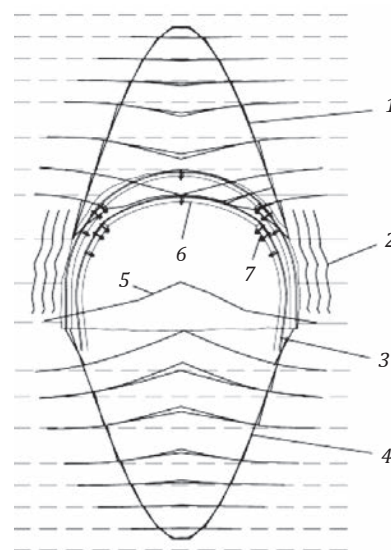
Схема деформирования системы крепь-массив вокруг выработки глубокой шахты: 1 – клин выдавливания в кровле; 2 – разрушение бортов; 3 – внедрение стоек крепи в подошву; 4 – клин выдавливания в подошве; 5 – поднятие подошвы; 6 – опускание кровли; 7 – смещение в замках.
